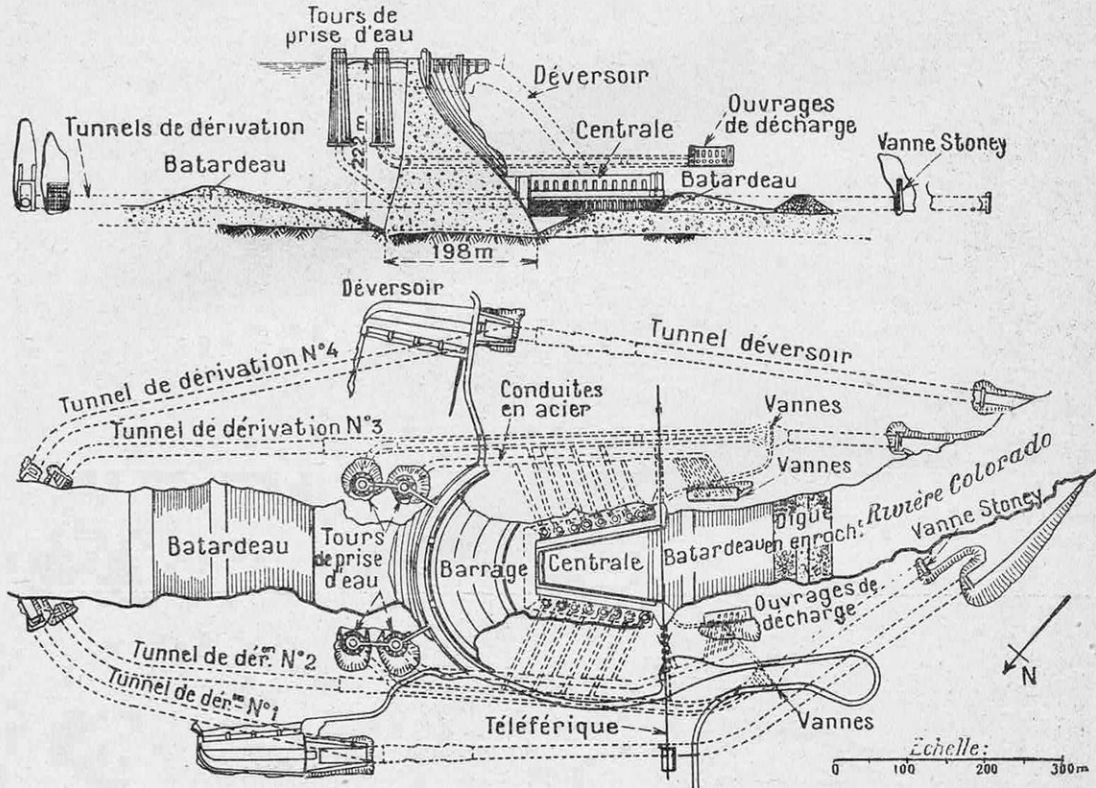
COUPE ET PLAN DES TRAVAUX DU BARRAGE « HOOVER »
